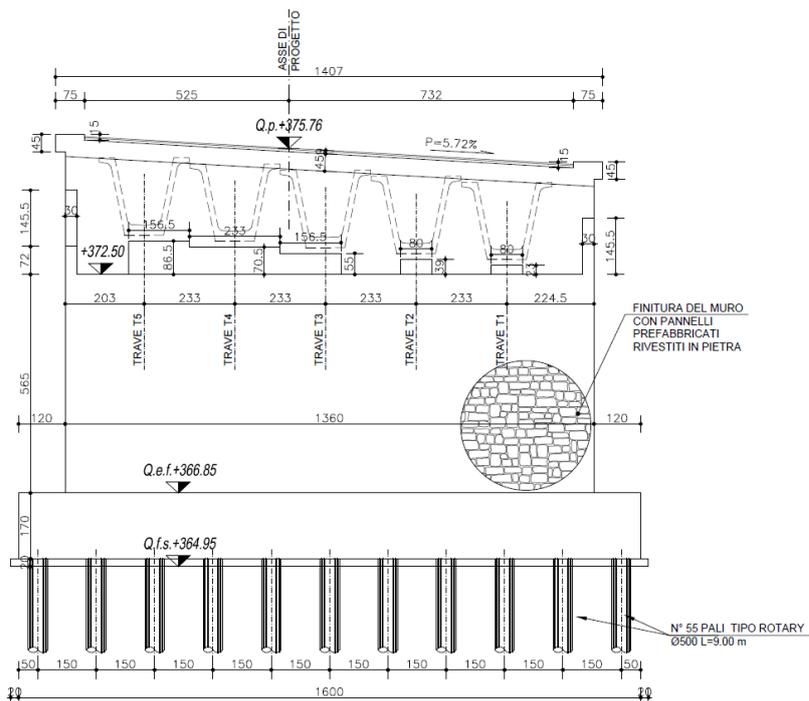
VISTA FRONTALE SPALLA SP2 VIADOTTO CASAL DEL MONTE
